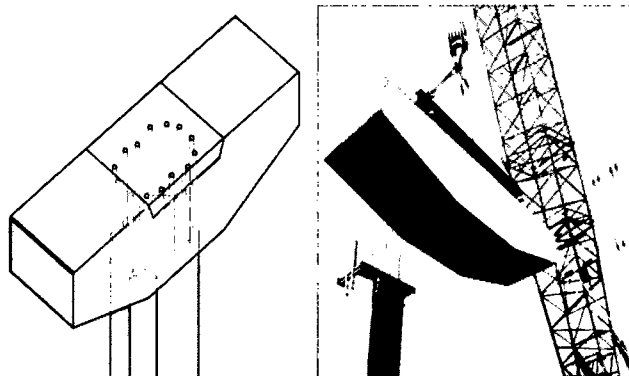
Prototipo de viga cabezal prefabricado y empleado en el Tramo 2.
